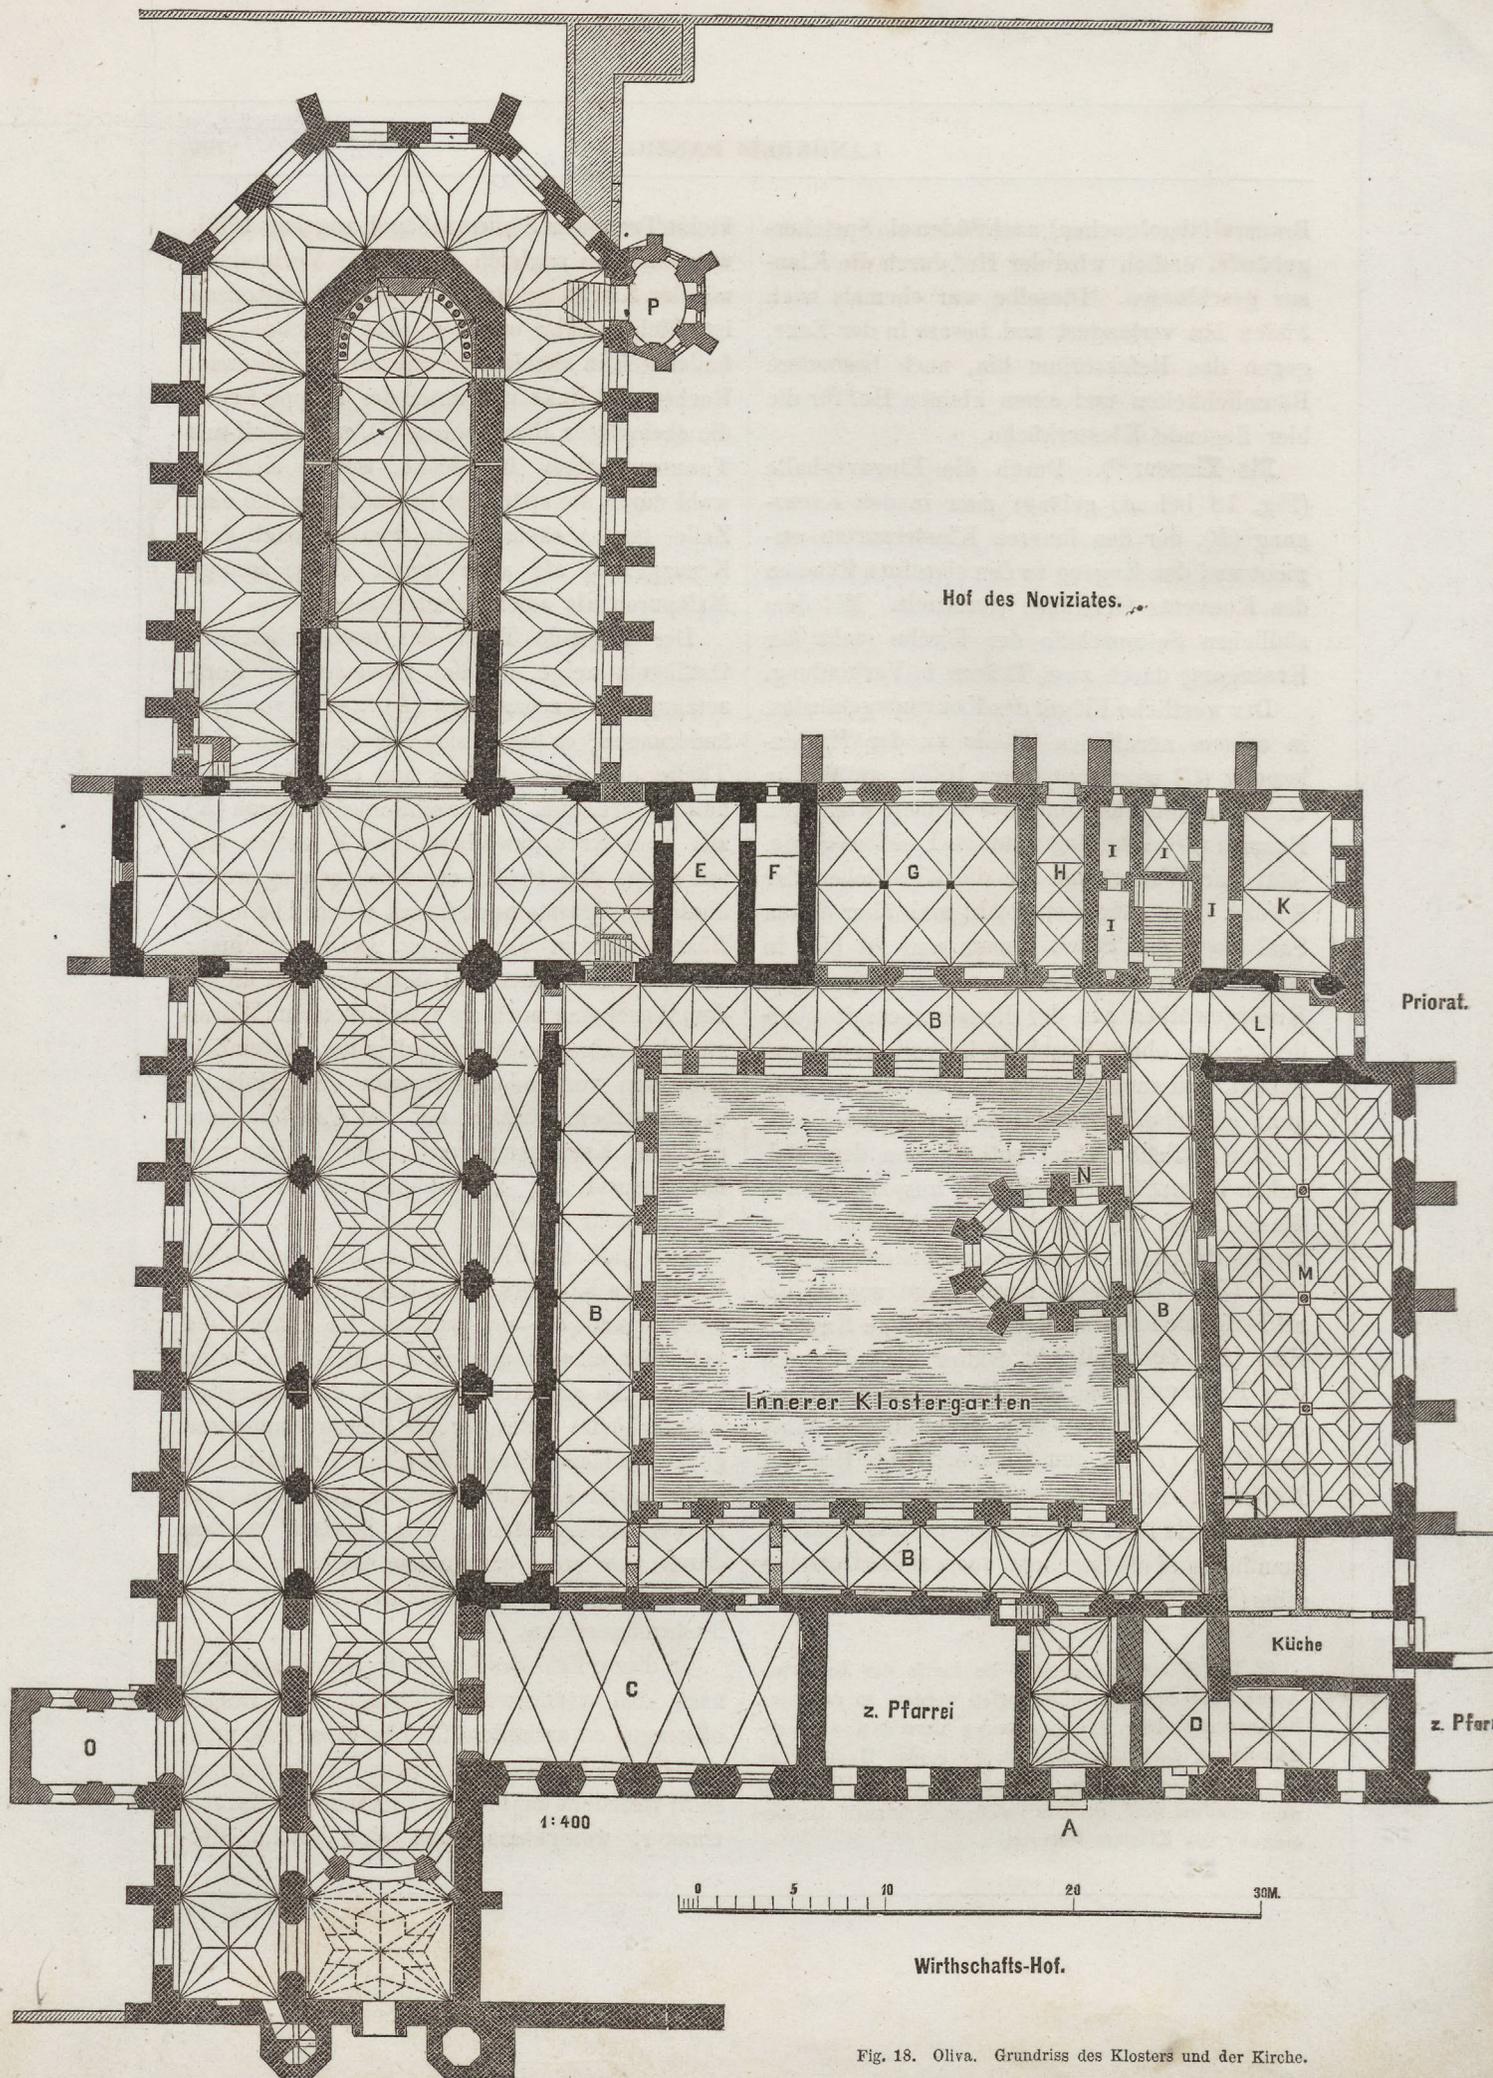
Oliva. Grundriss des Klosters und der Kirche.
